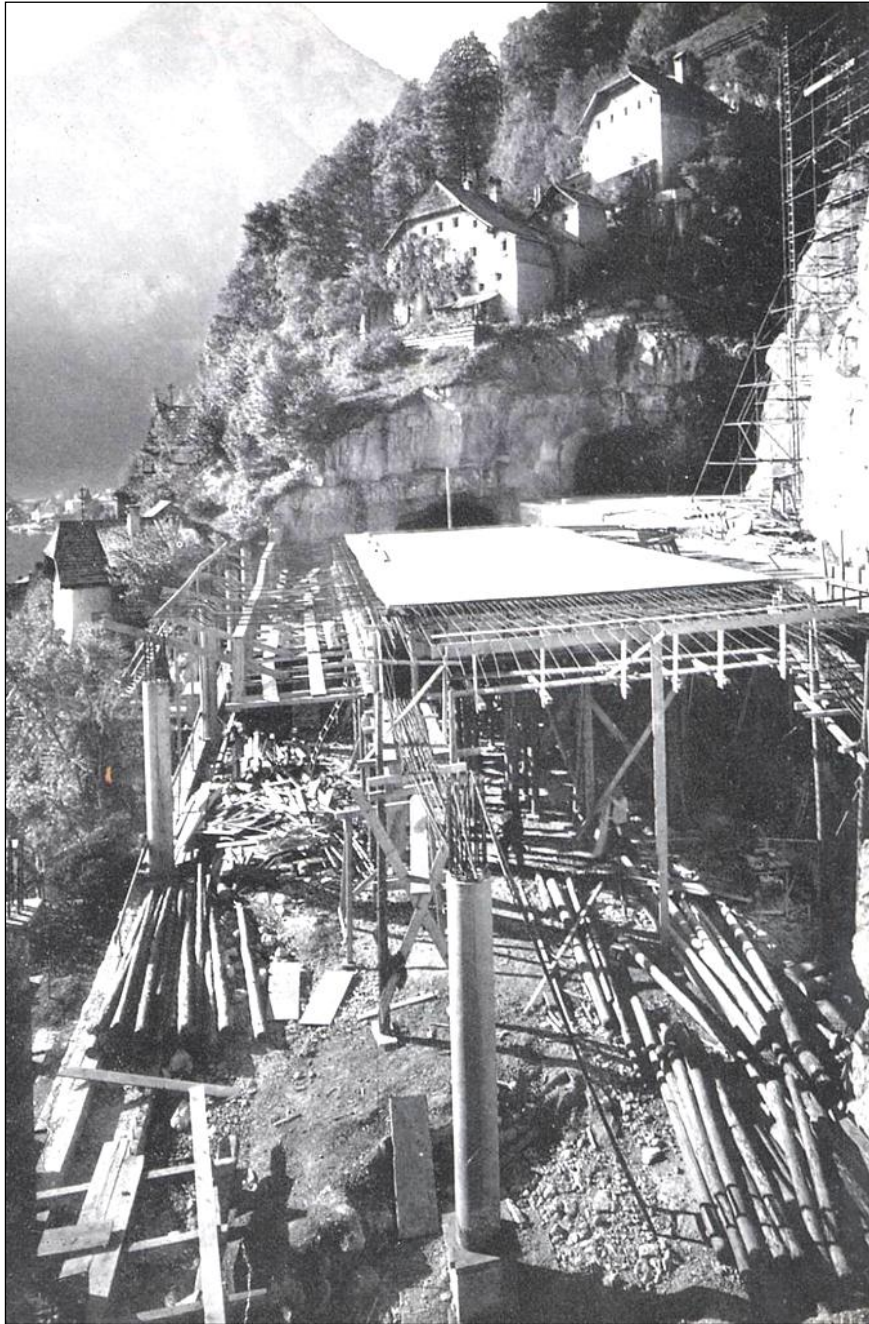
Ausgeführtes Projekt: Doppeltunnel mit Parkterrassen, Straßentunnel Hallstatt, Verlag der OÖ. Landesregierung, Linz
